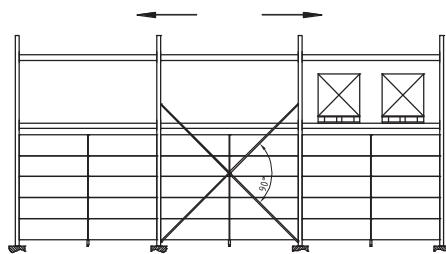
Стеллаж с перекрестными связями – устойчивая конструкция
